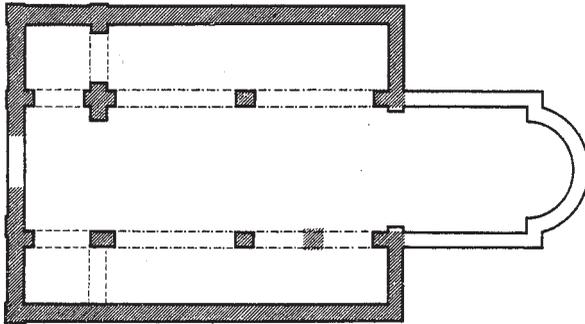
Rötha, Georgenkirche, Grundriss der romanischen Kirche mit Rekonstruktion des Chores, M 1:400
